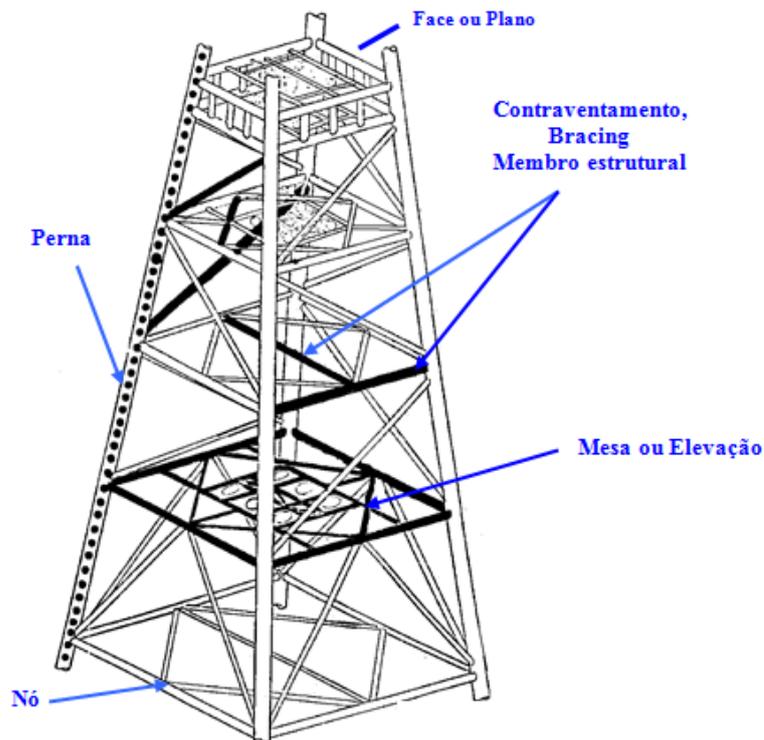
Estrutura metálica da jaqueta de plataforma fixa com seus elementos principais – trecho submerso
